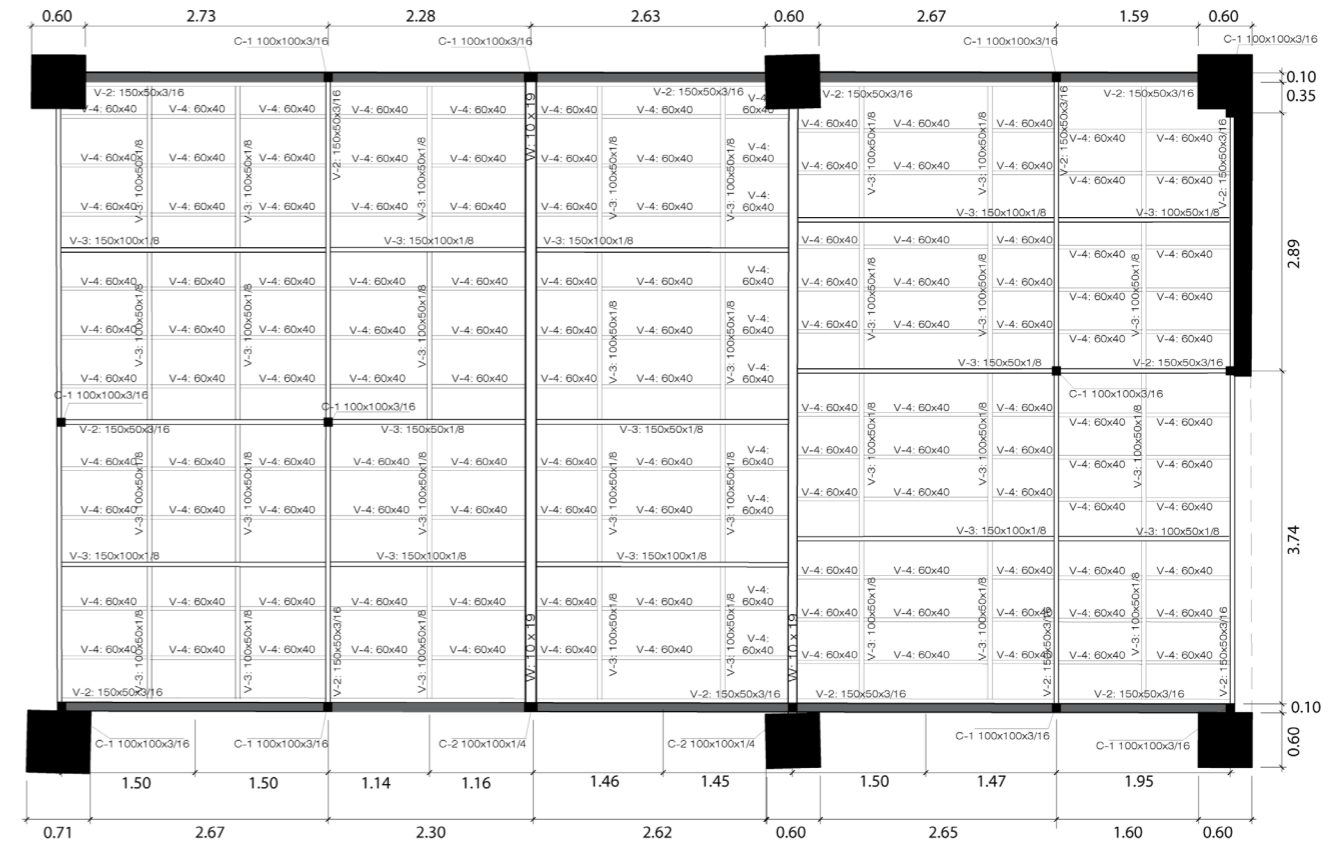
Montaje y fijación de vigas Principales y secundarias.
